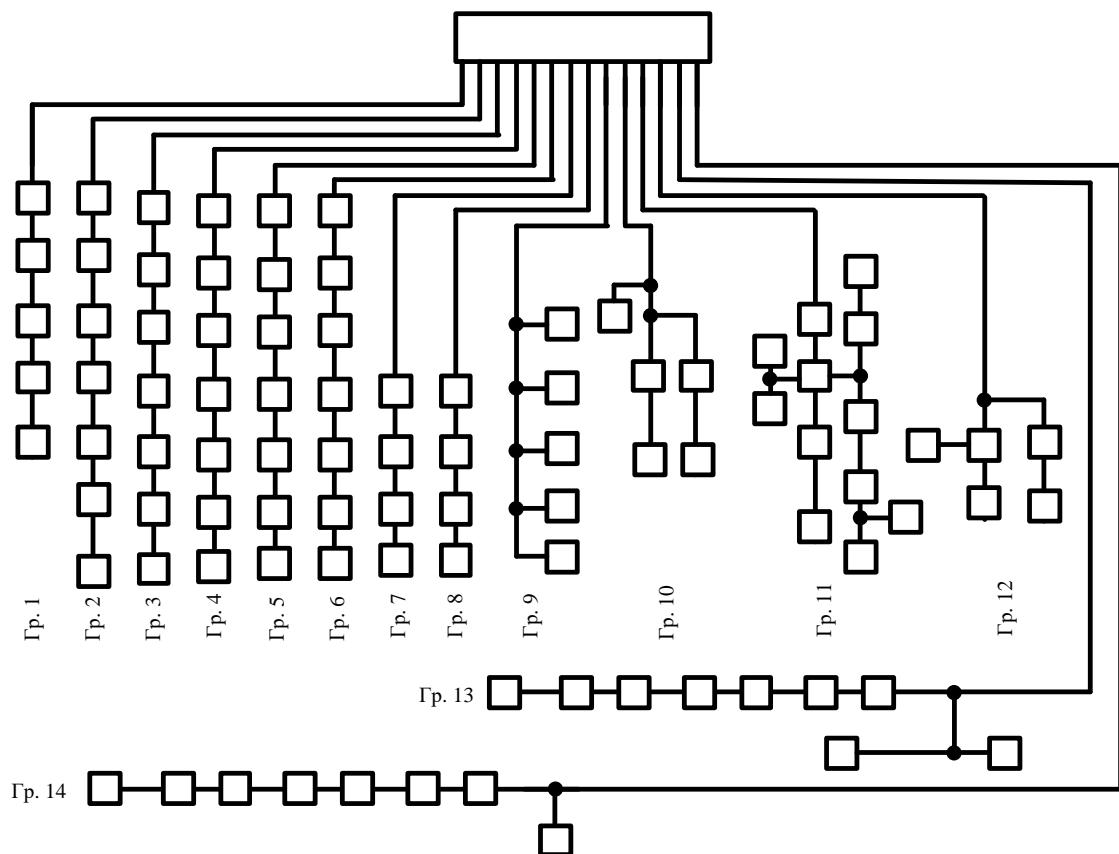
План разводки осветительной сети ЩО 1
